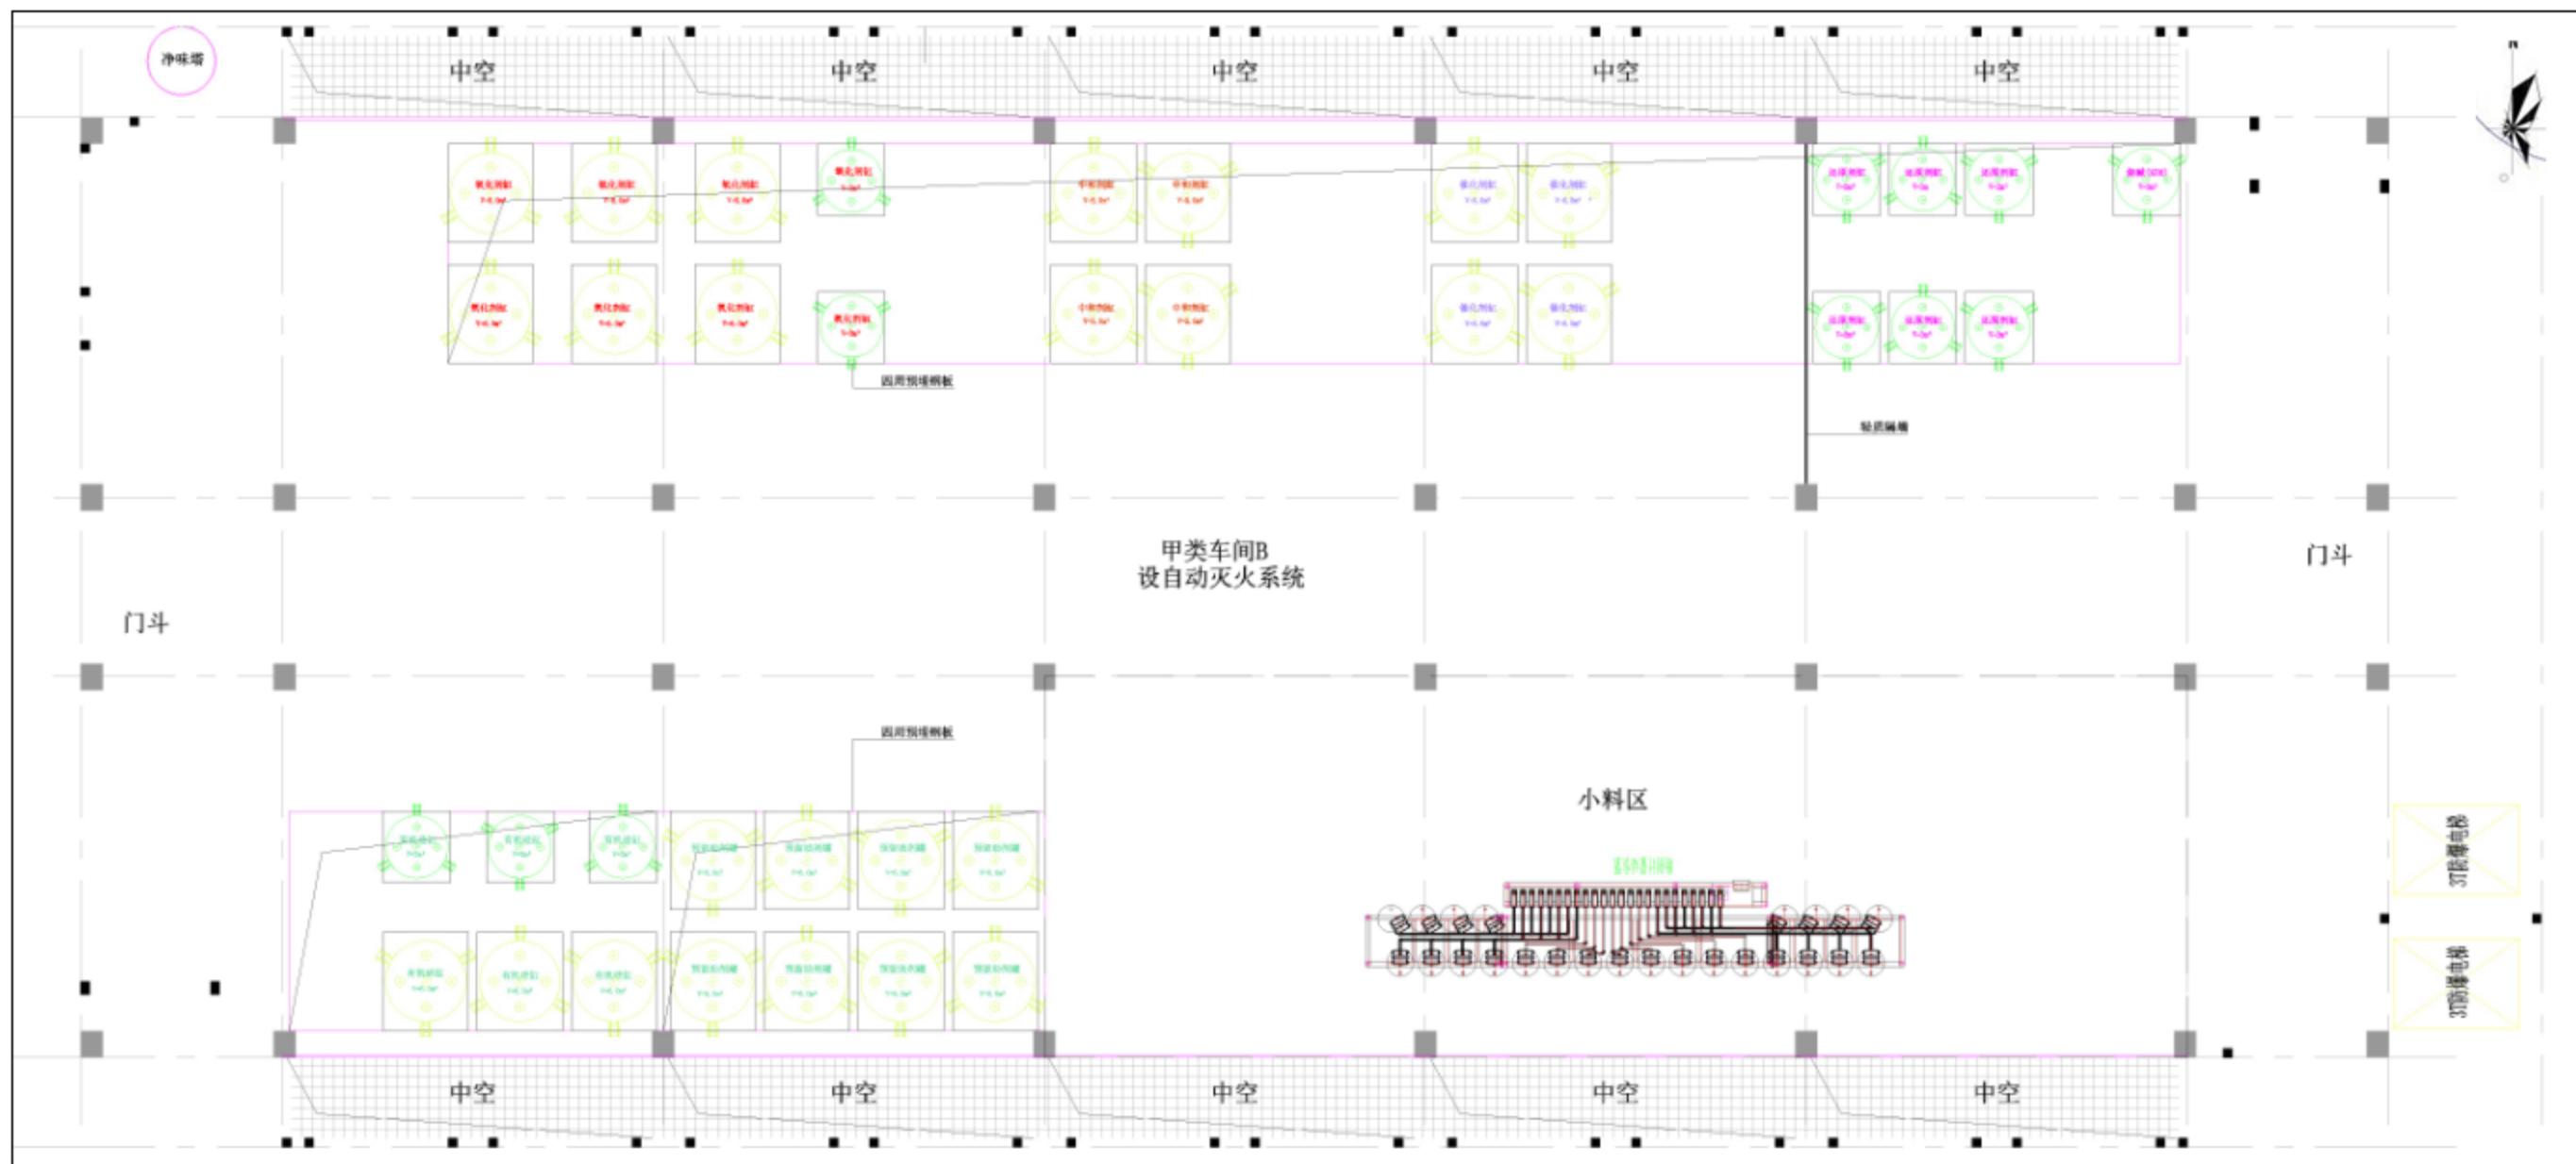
甲类车间B5层平面布置图(比例尺1:100)
